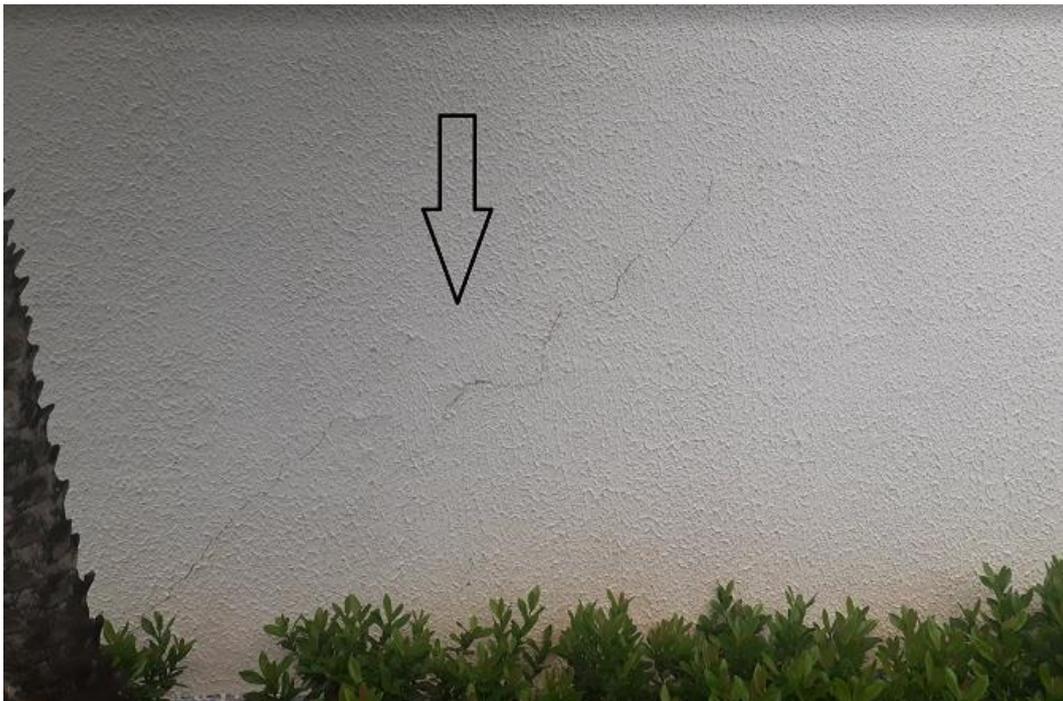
data 18/10/2021 Fachada externa - Fissura 45° apresentando deslocamento à 45° no sentido oposto a outra fissura (foto 5), provocada pelo rebaixamento do baldrame em decorrência do recalque de solo. Possível causa devido a umidade proveniente do jardim.
